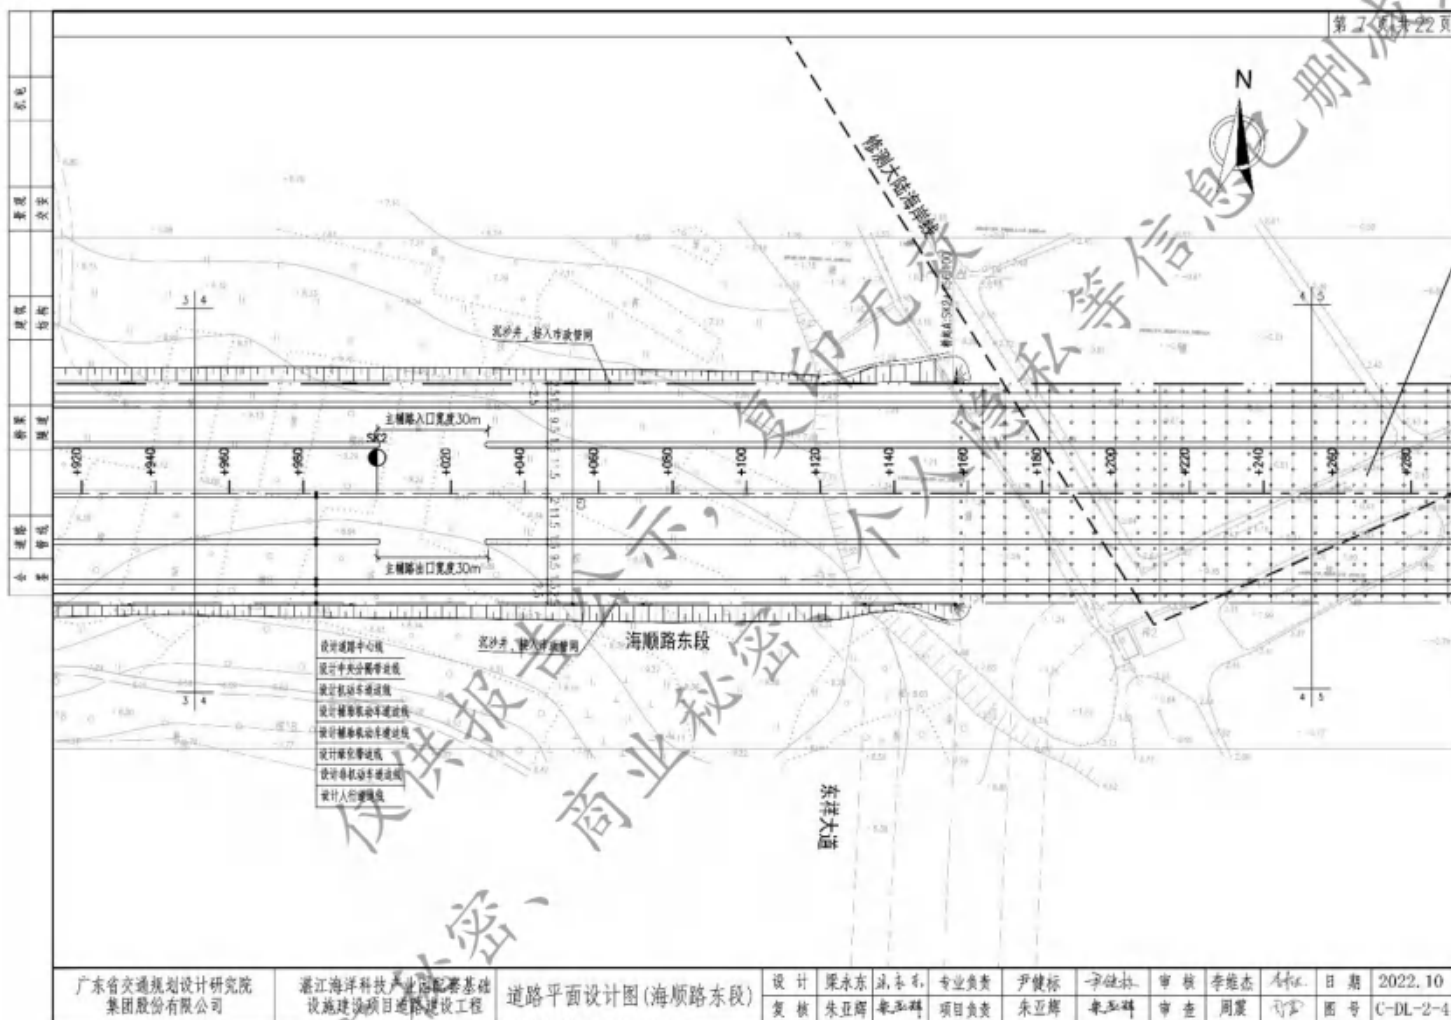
海顺路 2 号桥总平面布置图 (2)
